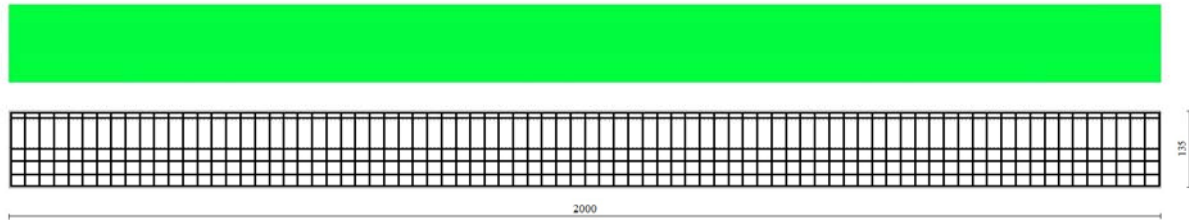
Piastra fondazione dir. Y (Inviluppo)
